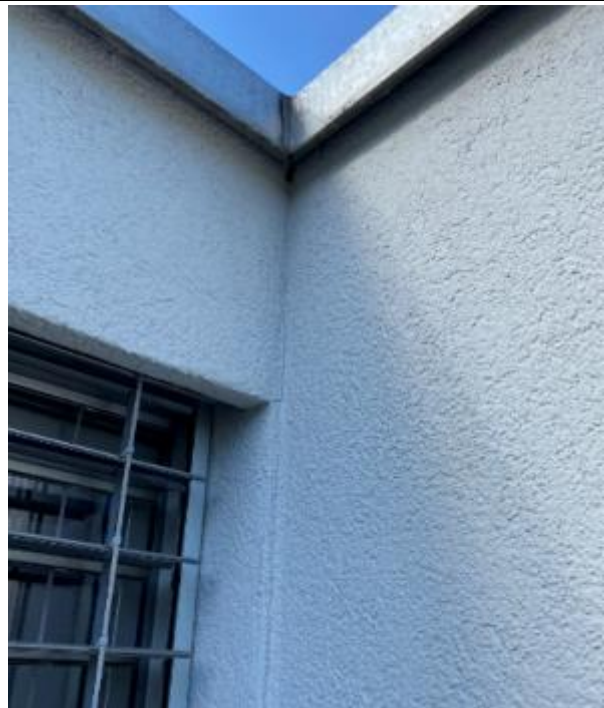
Terrasse T1 | Dachrand/Fassade
